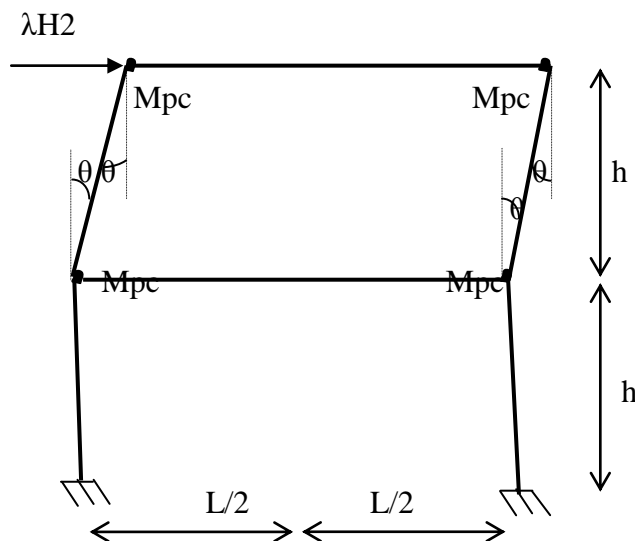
mécanisme N°4 des poteaux du 2<sup>eme</sup> niveau
